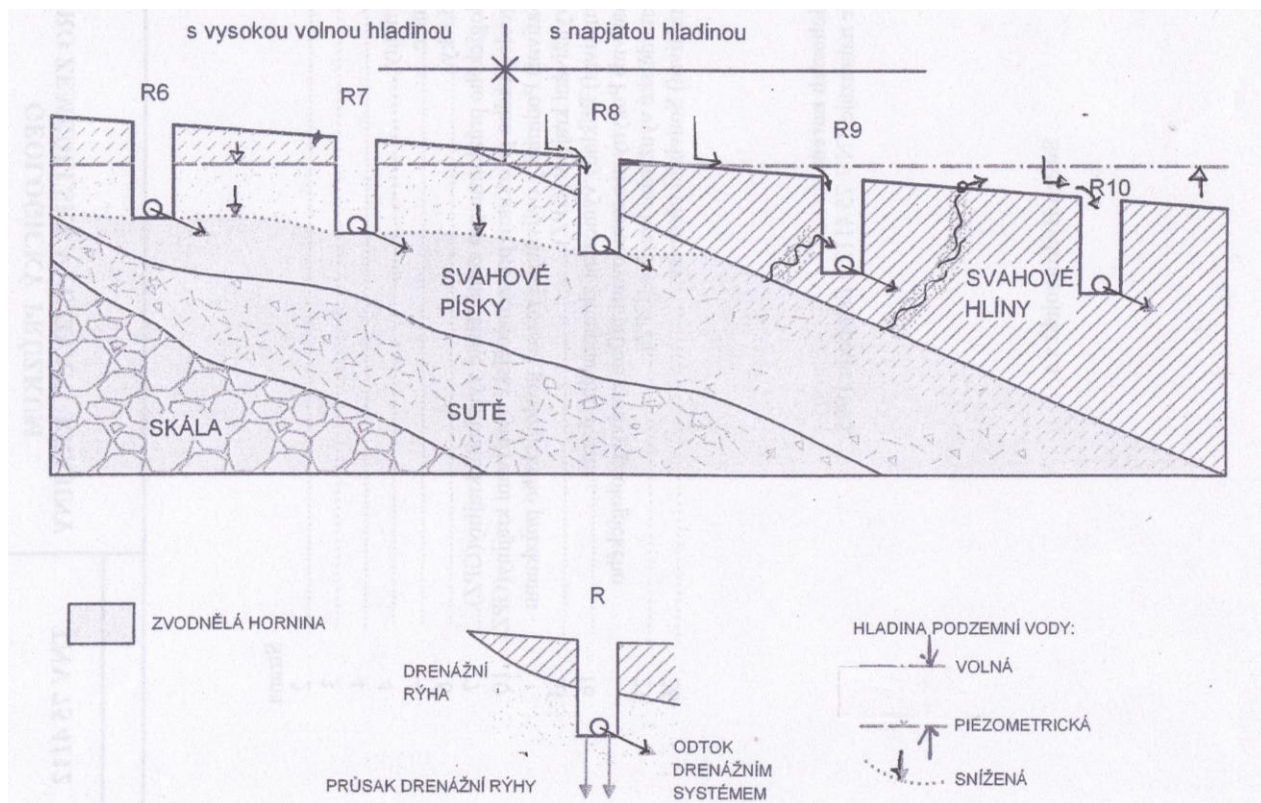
Odvodnění povrchově zamokřených pozemků
